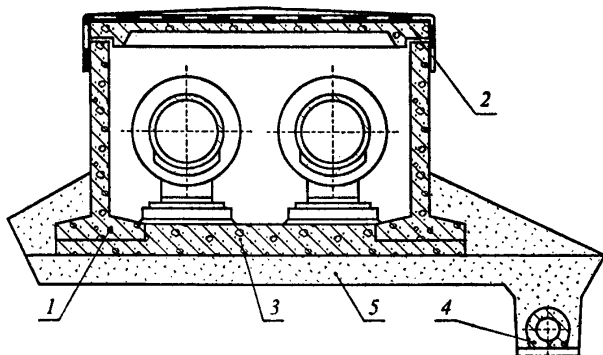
Канал из железобетонных тавровых стеновых блоков, ребристых плит перекрытия и плит дна с односторонним дренажем из керамзитобетонных трубофильтров:
